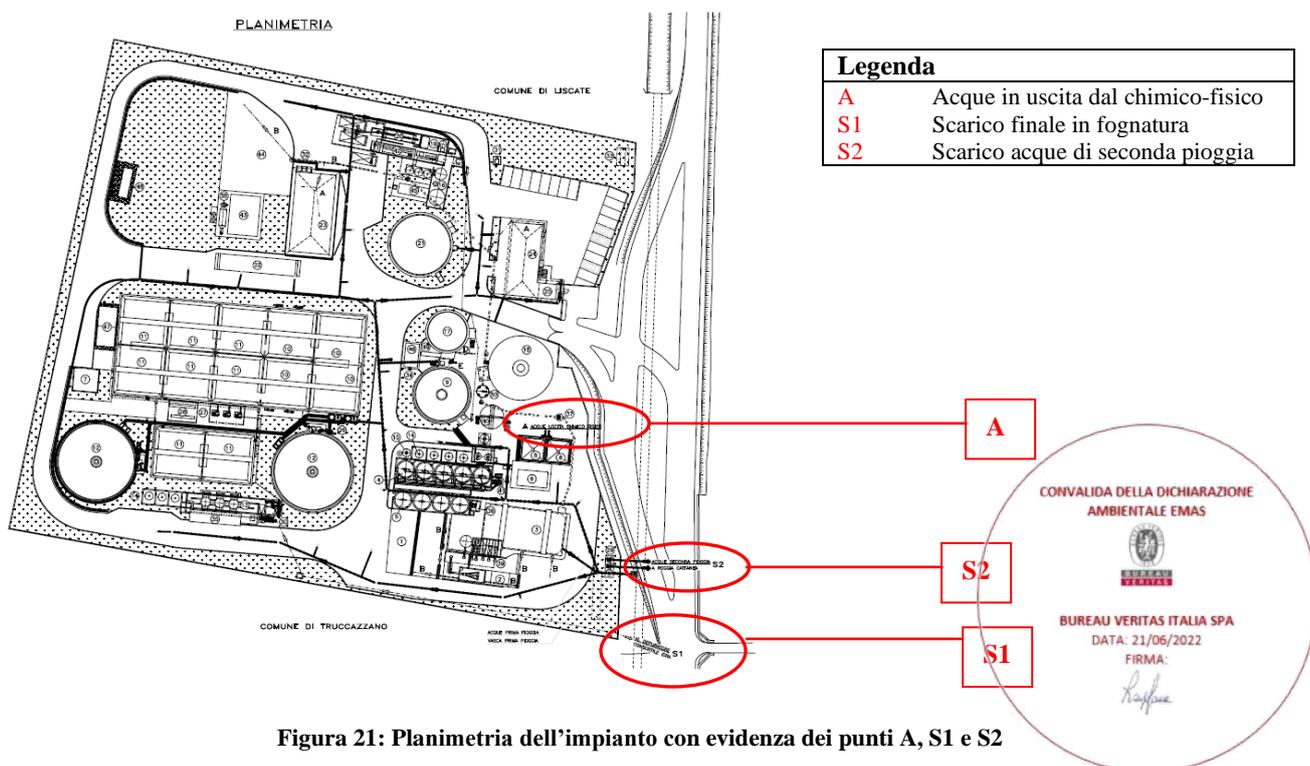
Planimetria dell'impianto con evidenza dei punti A, S1 e S2
